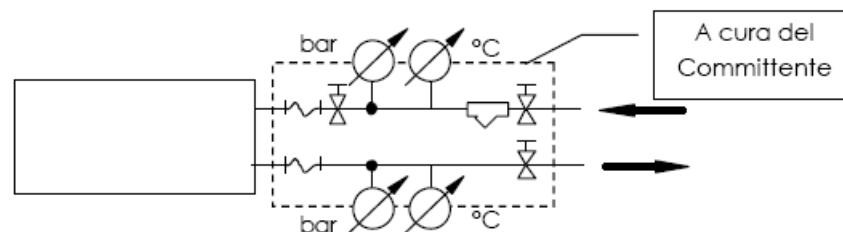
Schema di collegamento dell'unità all'impianto idraulico
